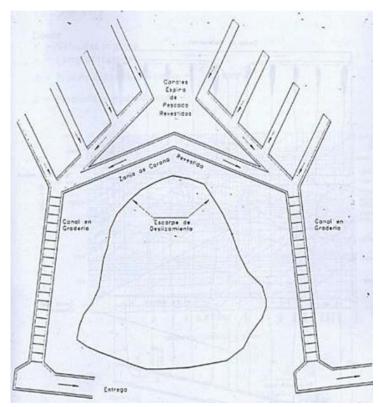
Esquema de planta de canales colectores espina de pescado con canales en gradería
